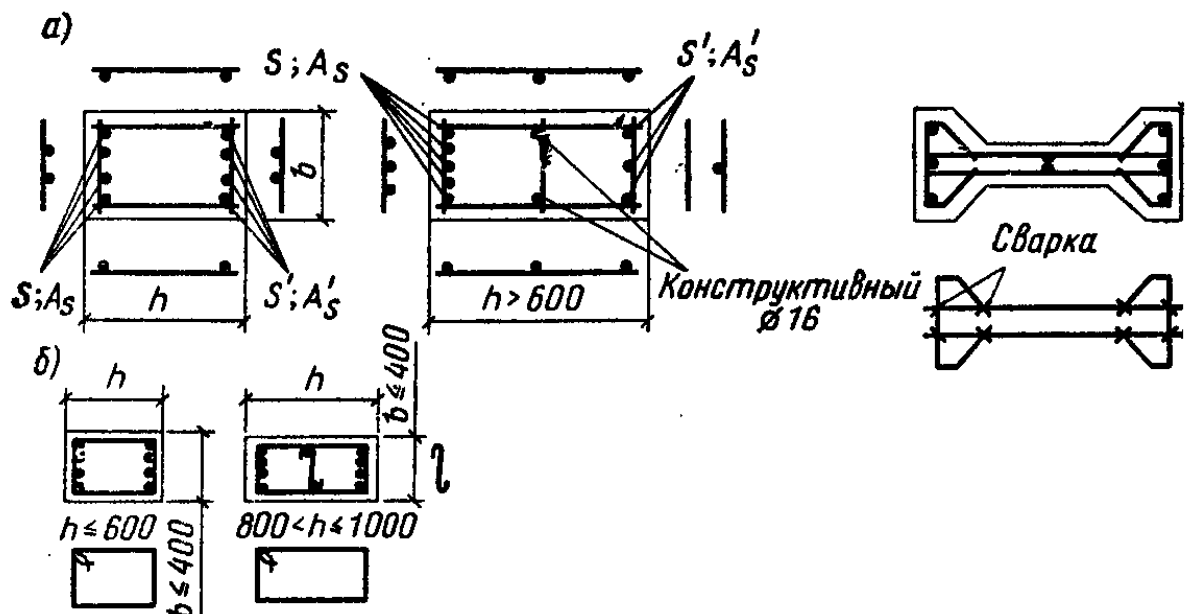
Армирование внецентренно сжатых элементов
